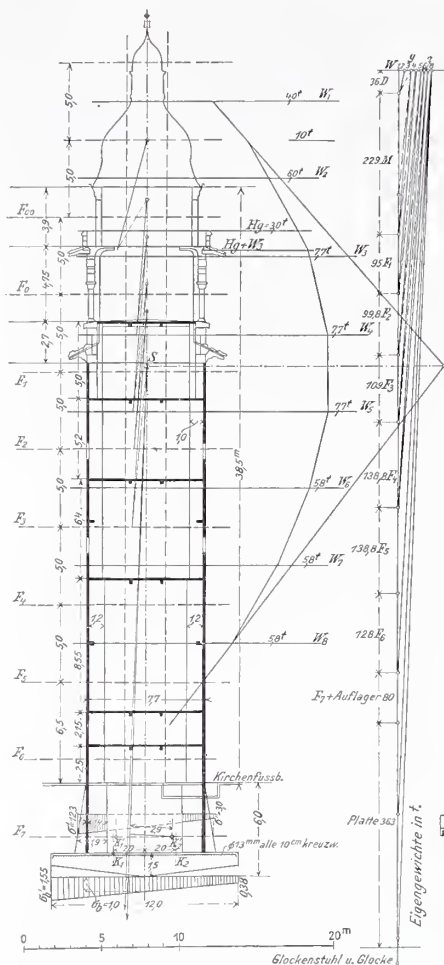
Ausführung des Eisenbeton-Kirchturmes.
